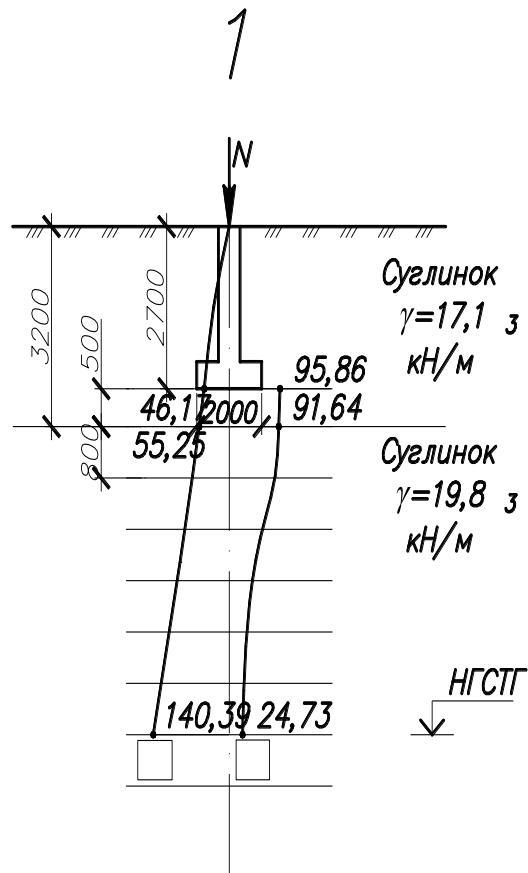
Осадка фундамента в сечении 1-1
